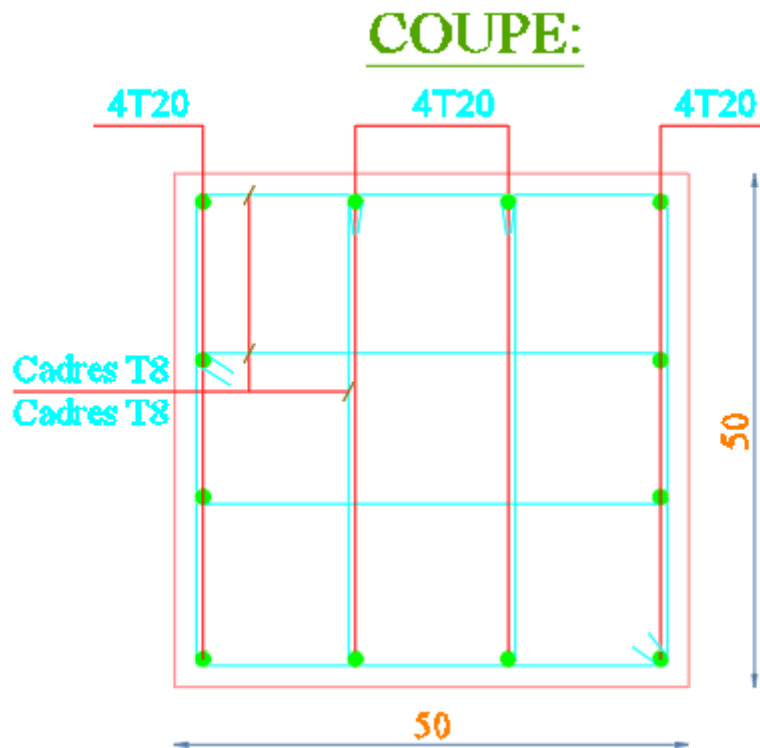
Schéma du ferrailage du poteau (50x50) cm²
